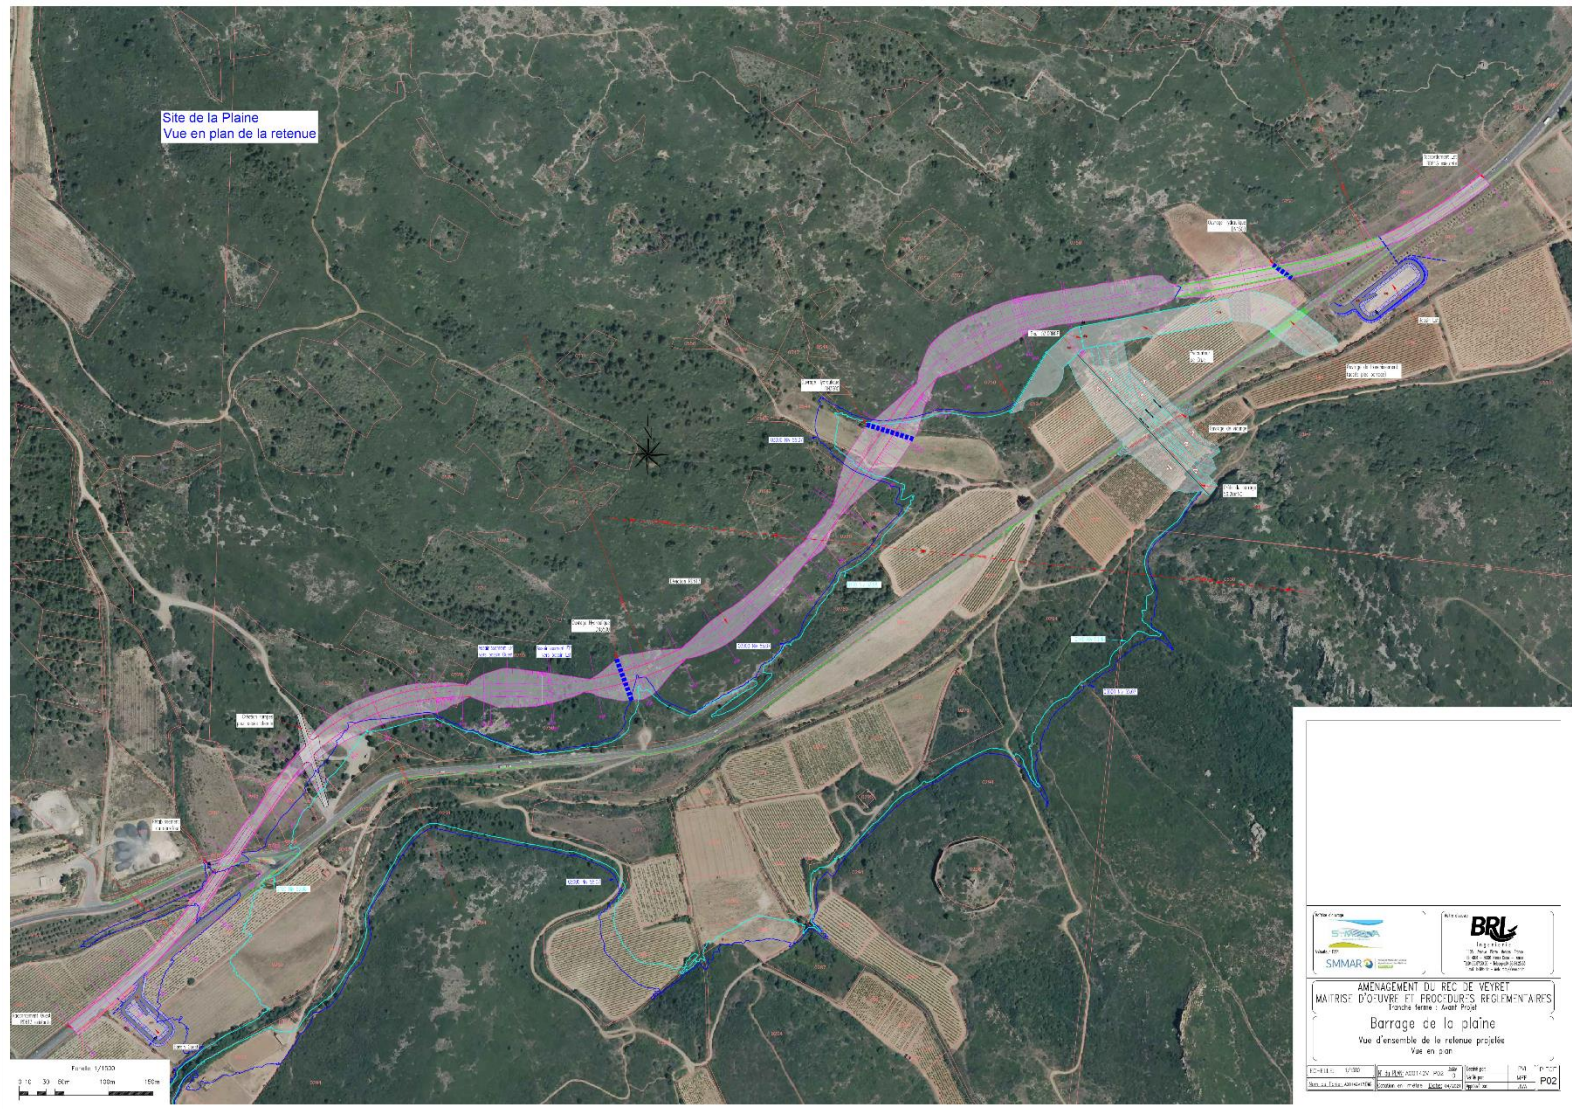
Vue en plan du site de Plaine-RD613 et de la déviation
